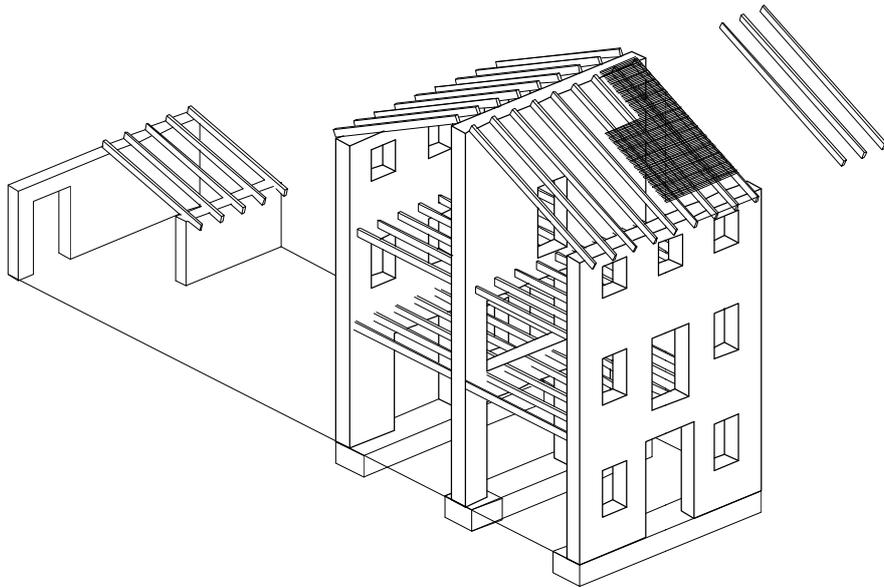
Modelo hipotético simplificado de construcción urbana entre medianeras hasta el s. XVIII. Consta de dos crujías con muros paralelos a fachada, patio posterior y construcción anexa ("pallissa").
